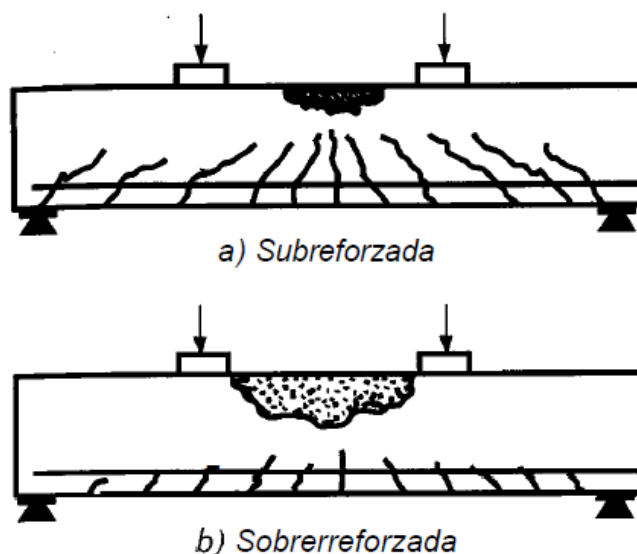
Agrietamiento de las vigas de acuerdo al porcentaje de acero
